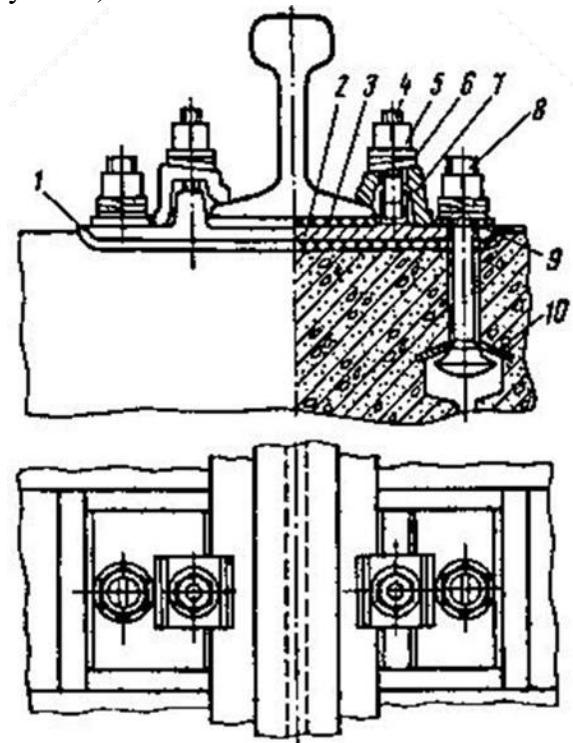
Раздельное скрепление КБ для железобетонных шпал:
